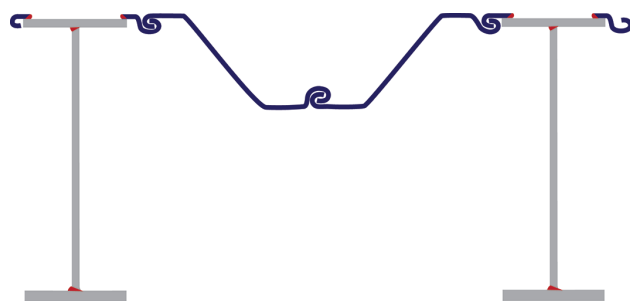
Несущая свая в виде сварной разнополочной и разнотолщинной балки с «облегченной» х/к ПФЗ
